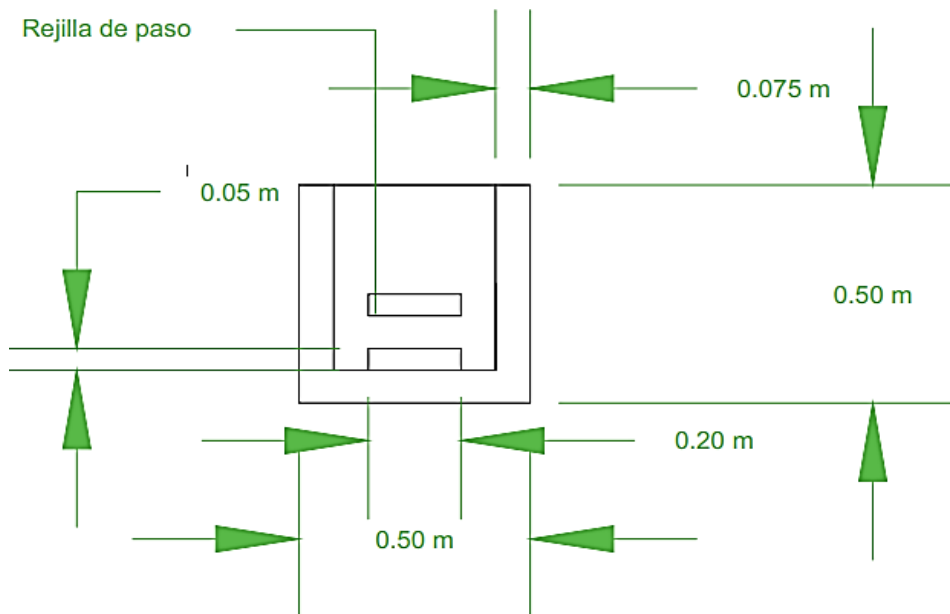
Vista frontal de escalón del canal zigzagueante
